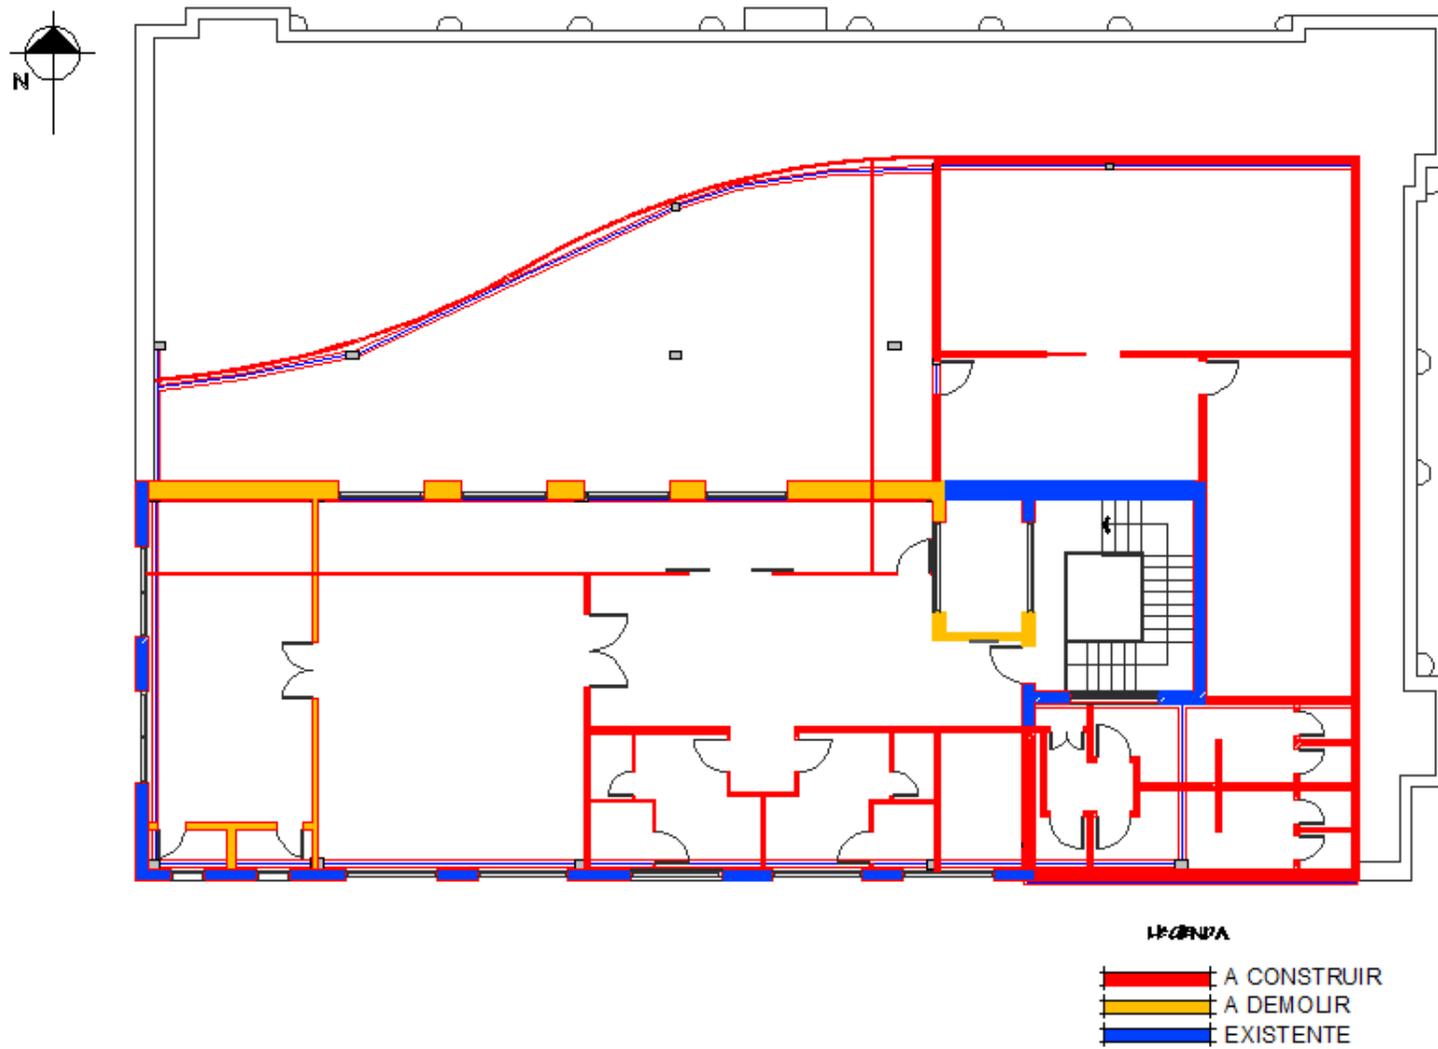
Planta Baixa Reforma Terceiro Pavimento.
